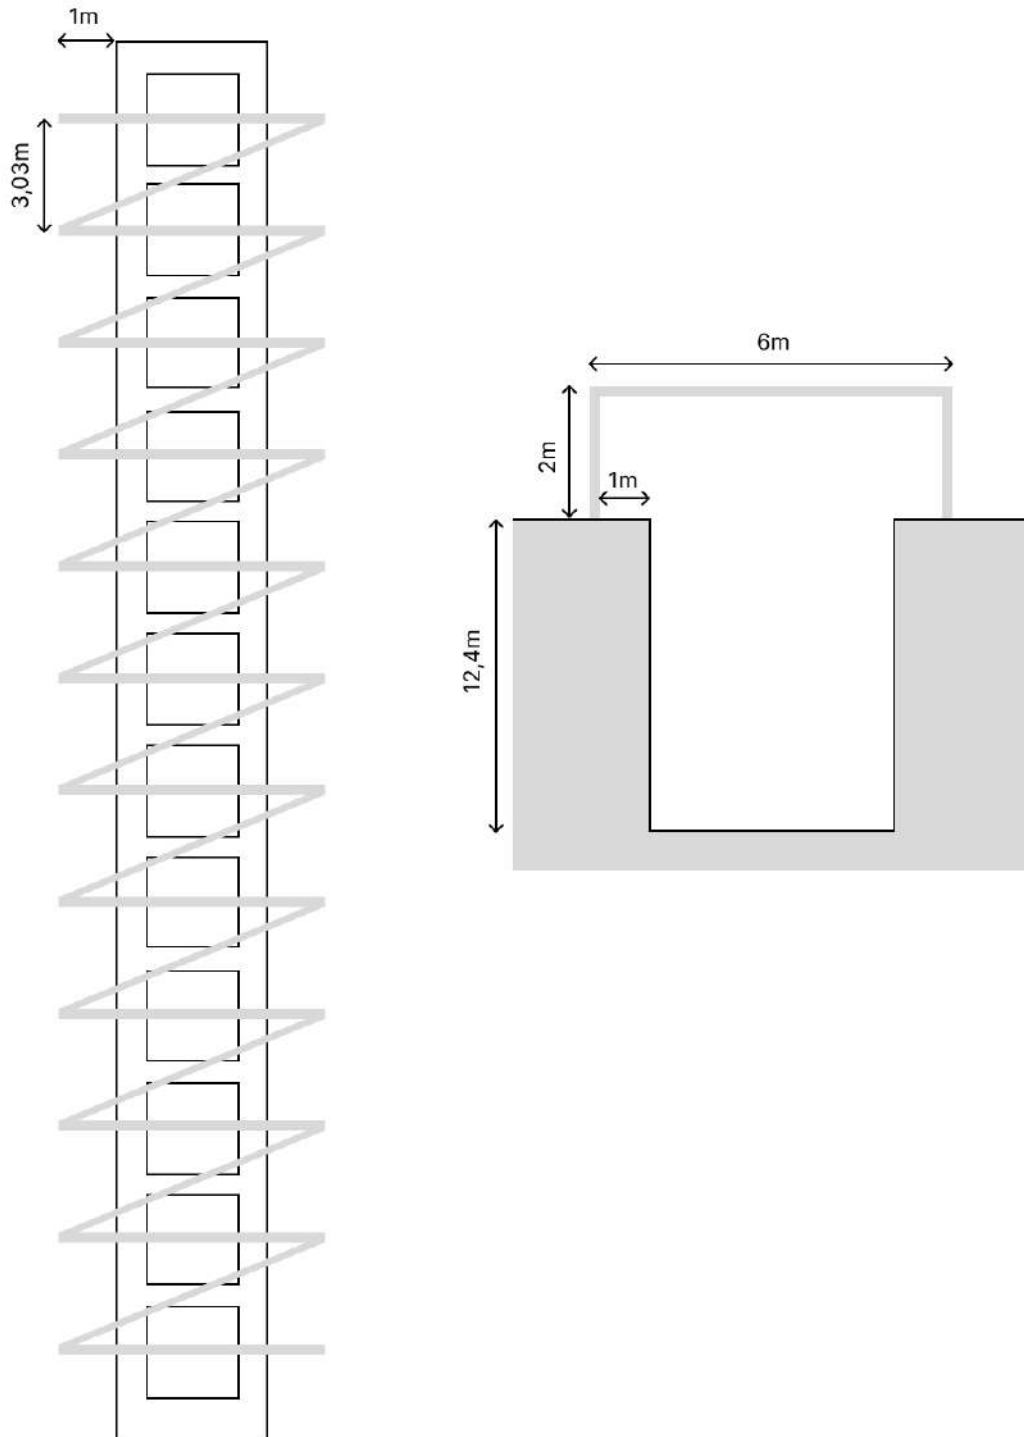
Vista aéreo y frontal de piletón Fuente: Elaboración del autor
